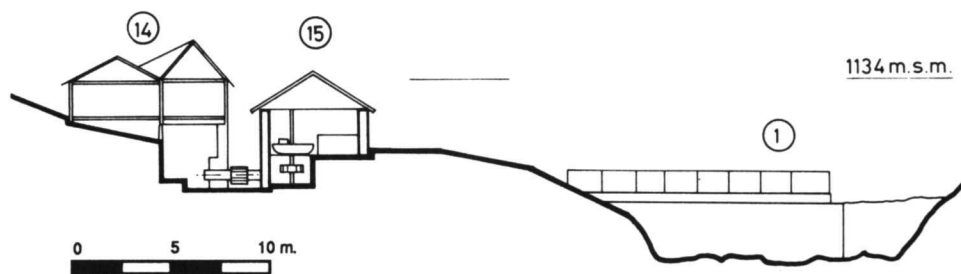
Profil en travers de la scierie et de la ribe («Archéotech» 112/3)
